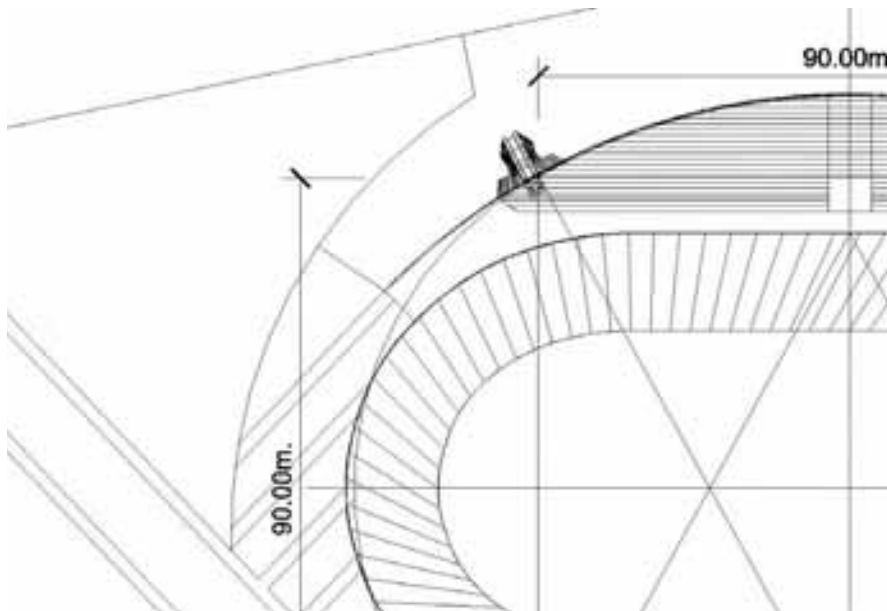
Vista de la planta en donde se han ubicado los soportes.
